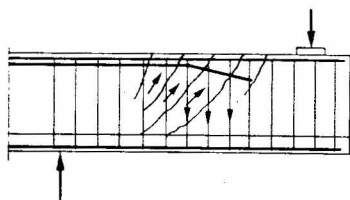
Disposition avantageuse des bouts des armatures principales dans la zone de cisaillement (d'après LEONHARDT)
